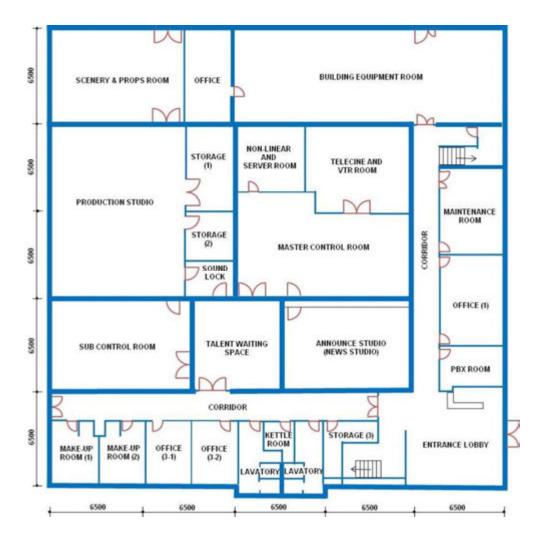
カブール・テレビ放送局 1 階平面図
